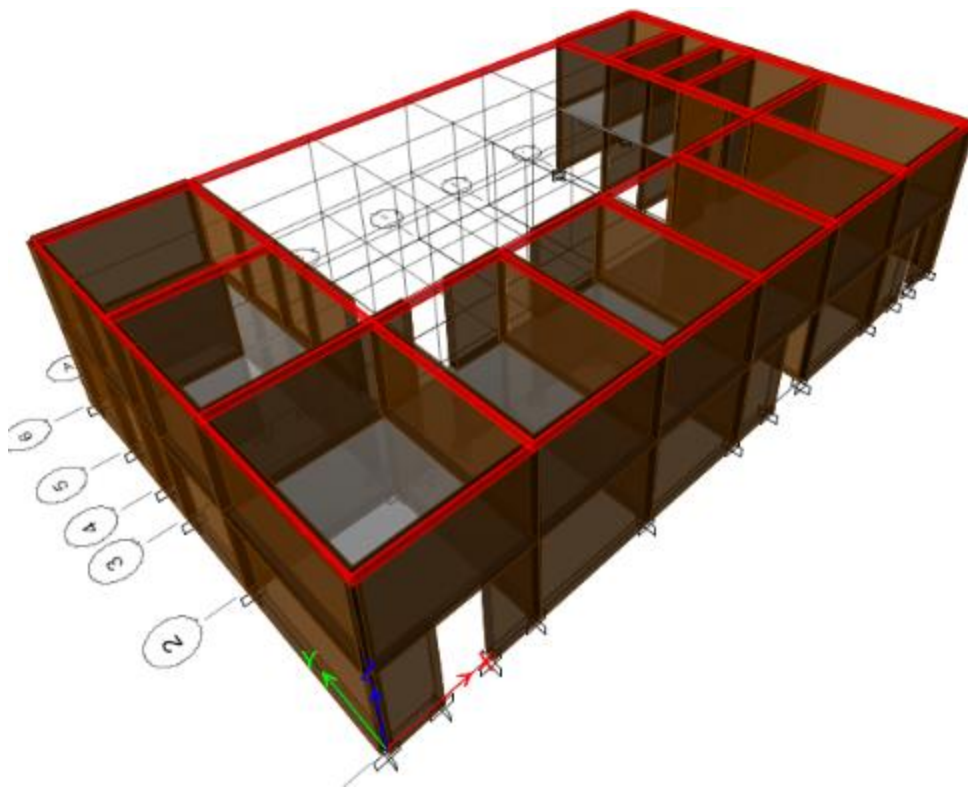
Vista tridimensional del local municipal de Acraquia reforzada con madera. Fuente: Elaboración propia.
